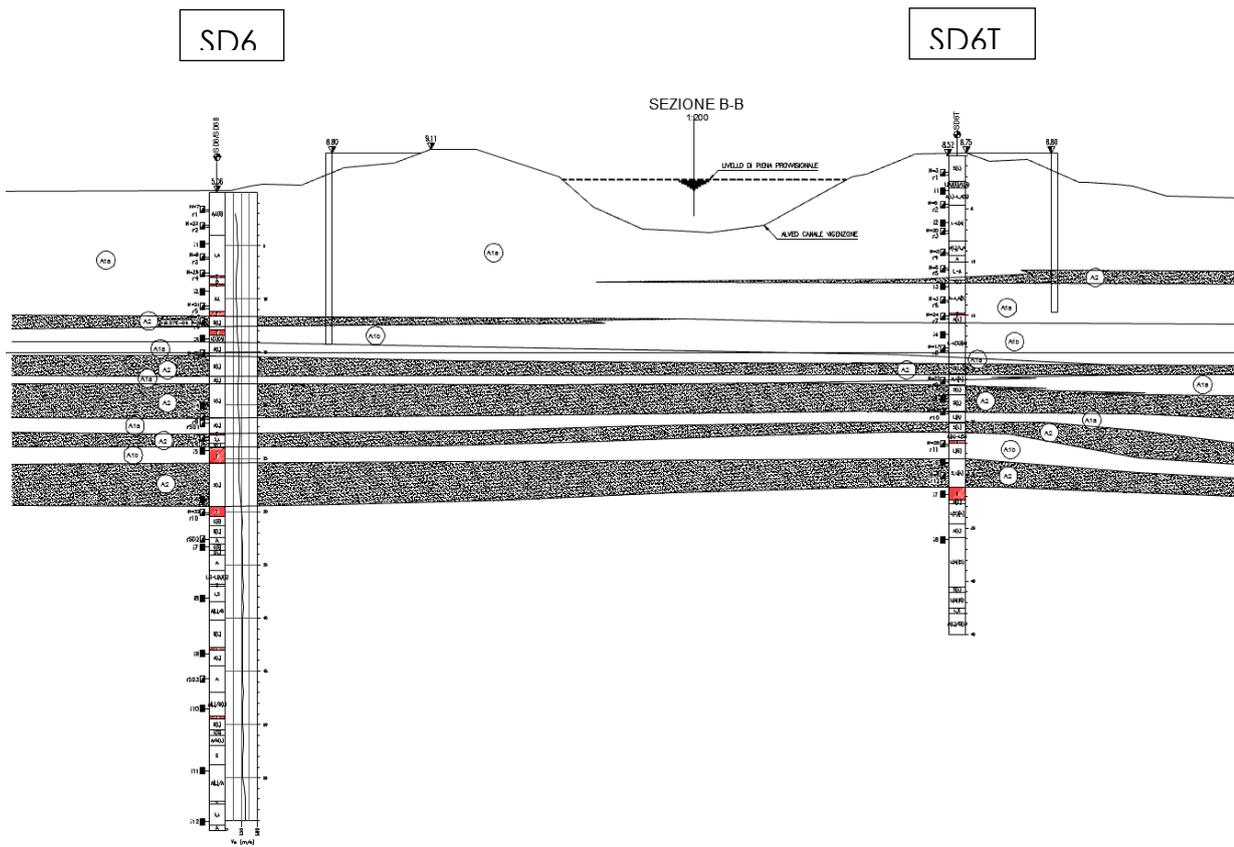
Ponte Canale Vigenzone - Sezione geotecnica B-B
